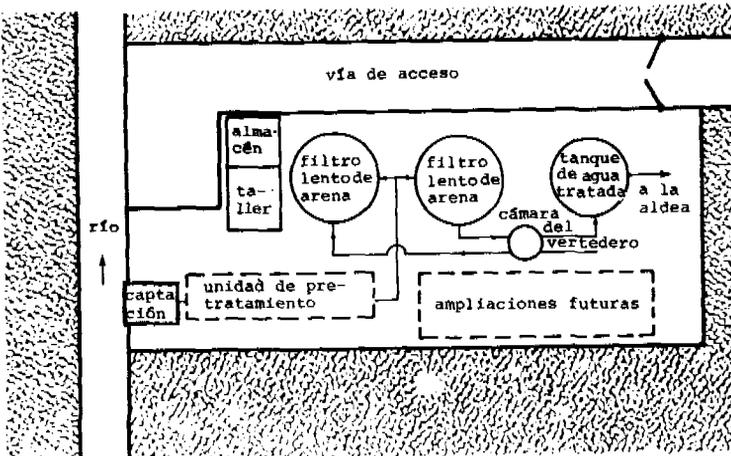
Esquema de planta de tratamiento que comprende el diseño típico No. II.
